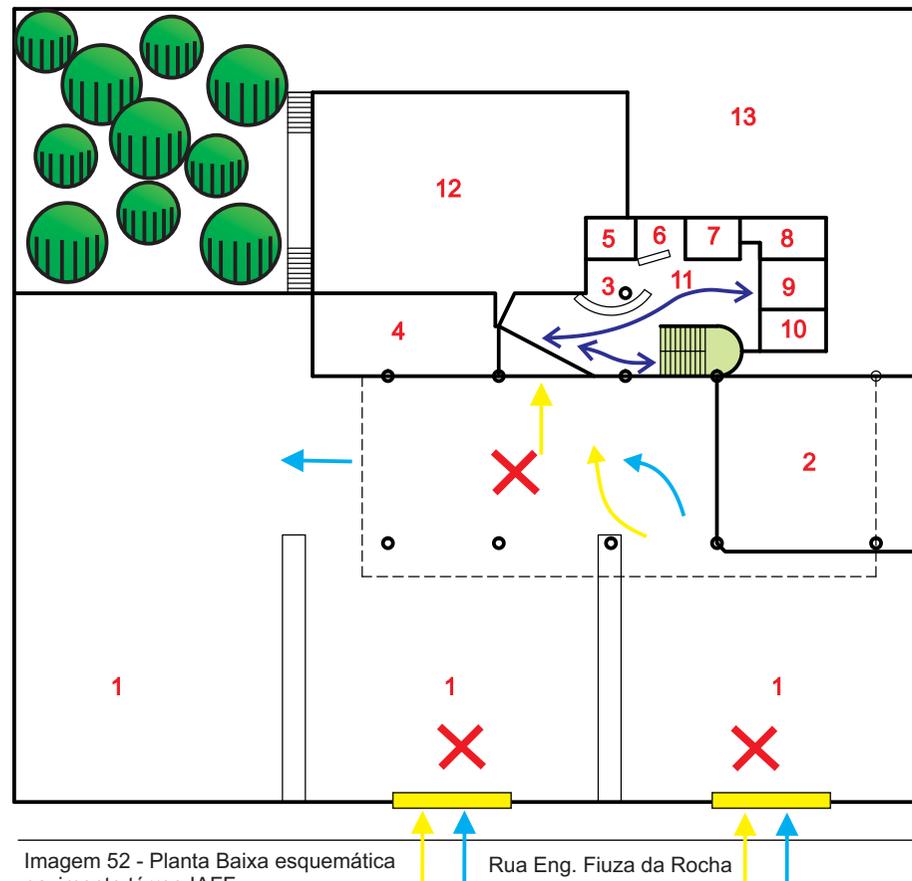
Planta Baixa esquemática pavimento térreo IAFF. Fonte: acervo do autor
